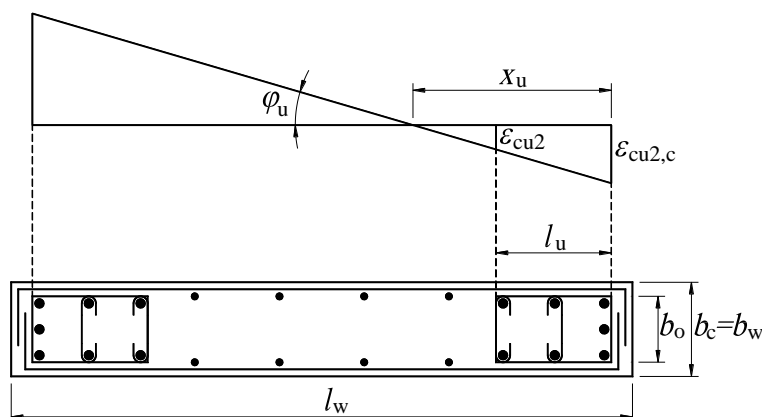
Ограниченные периферийные участки со свободными гранями в торце стены (вверху: деформации при предельной кривизне; внизу: поперечное сечение стены)
